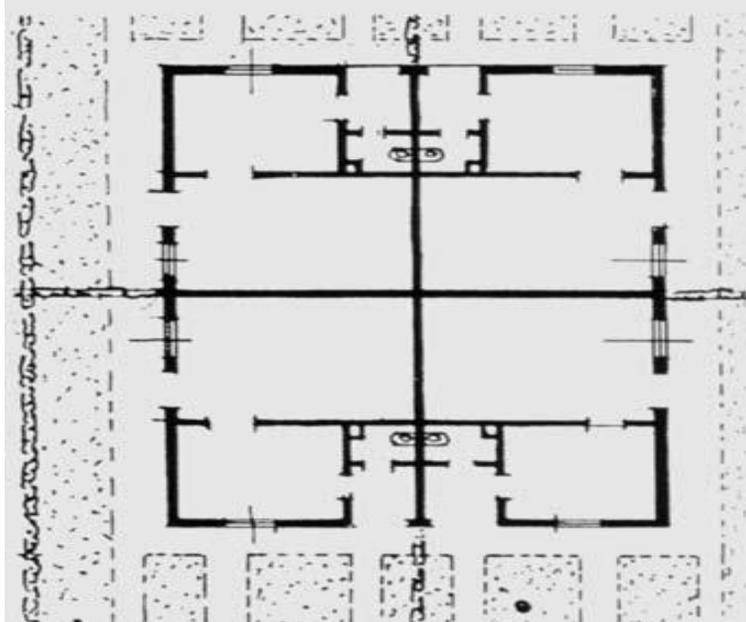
Barrió Obrero Centenario. Planta Arquitectónica de vivienda, 1938.
